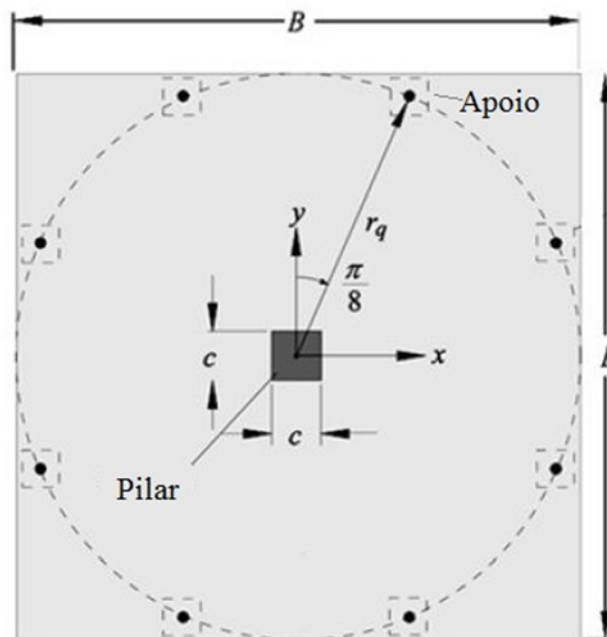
Geometria de um modelo de laje e esquema do ensaio, vista em planta. Muttoni [61]
